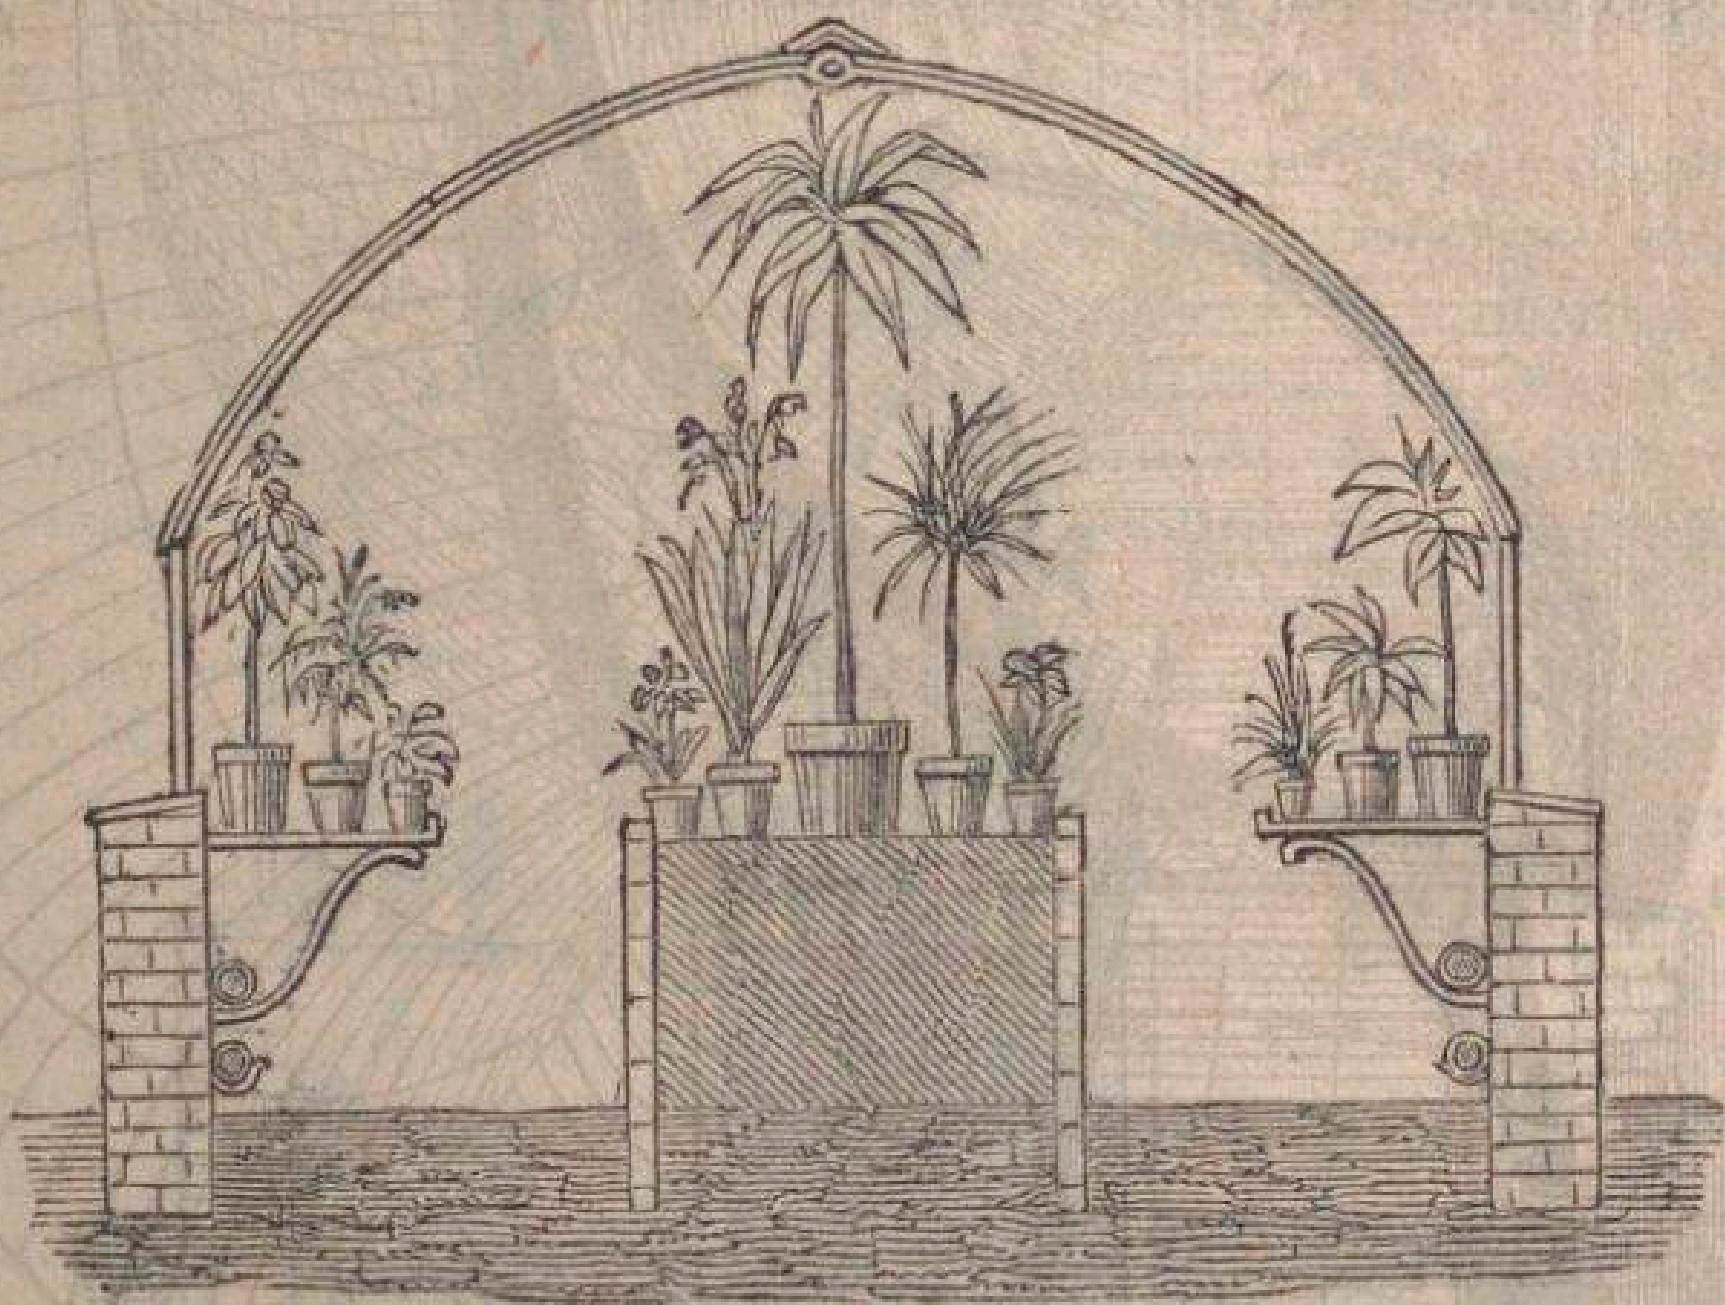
Serre à double pente en fer, coupe vue debout.
